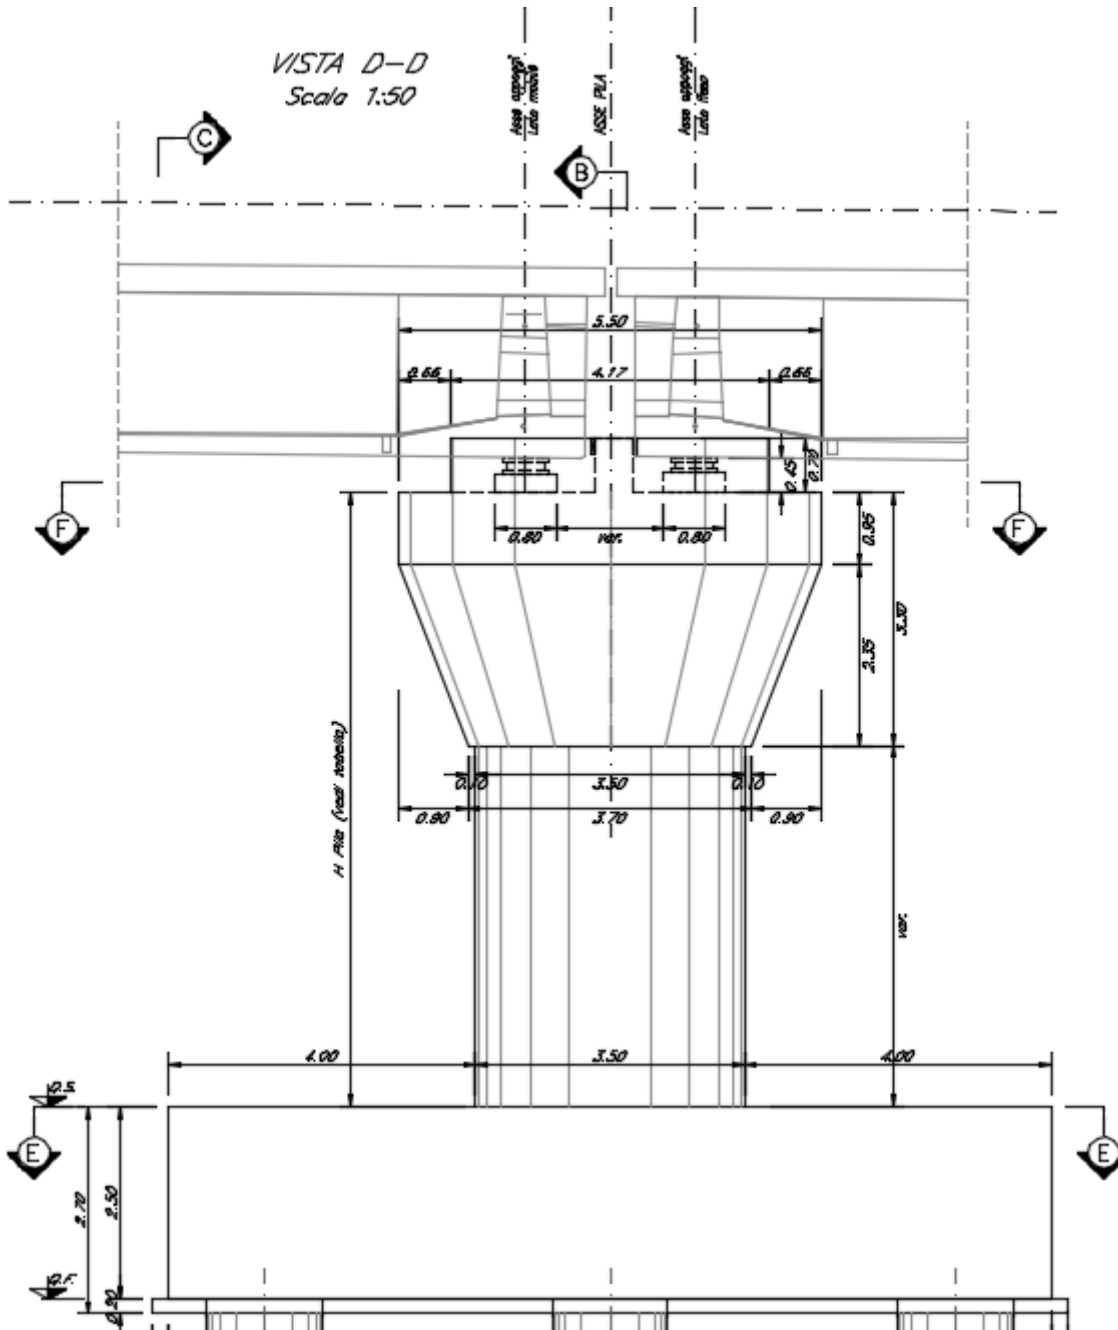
Pila circolare singolo binario – prospetto longitudinale
